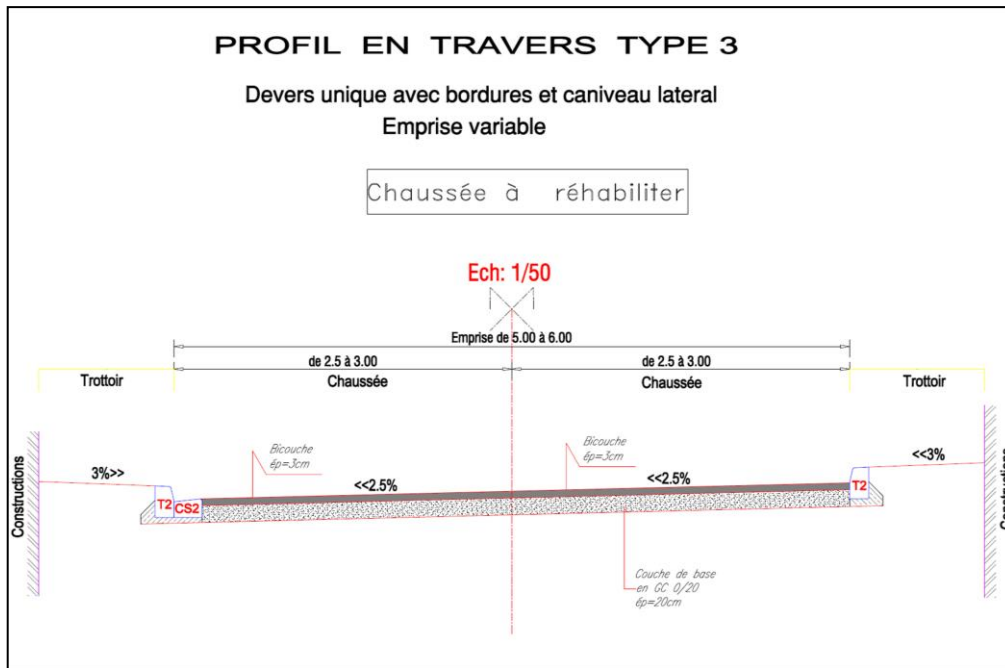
Coupe type du corps de chaussée-Aménagement type 3
